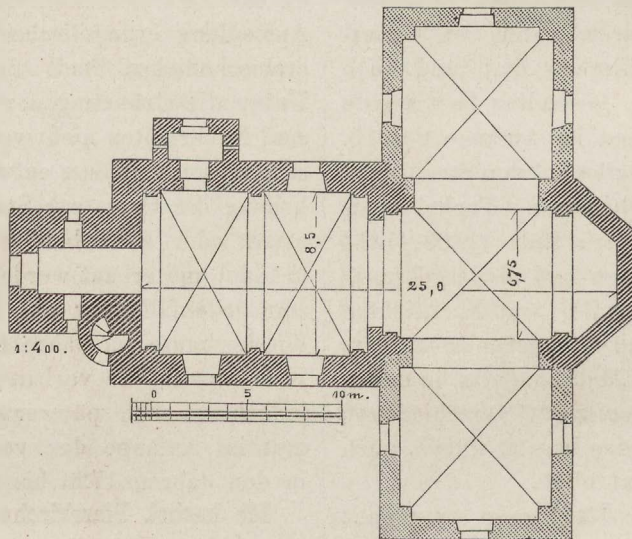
Kamin. Grundriss der kathol. Kirche.
